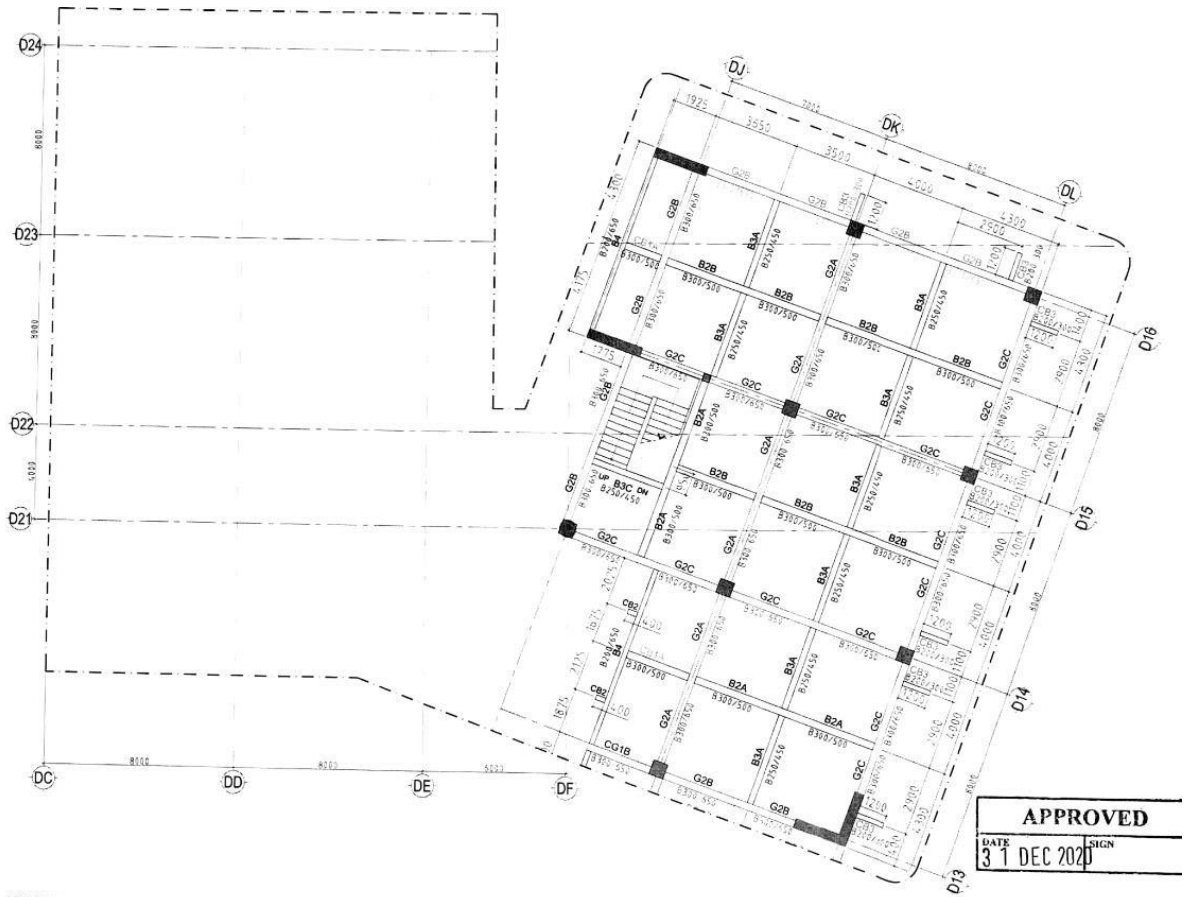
Denah Parsial 2 Balok Lantai 4
